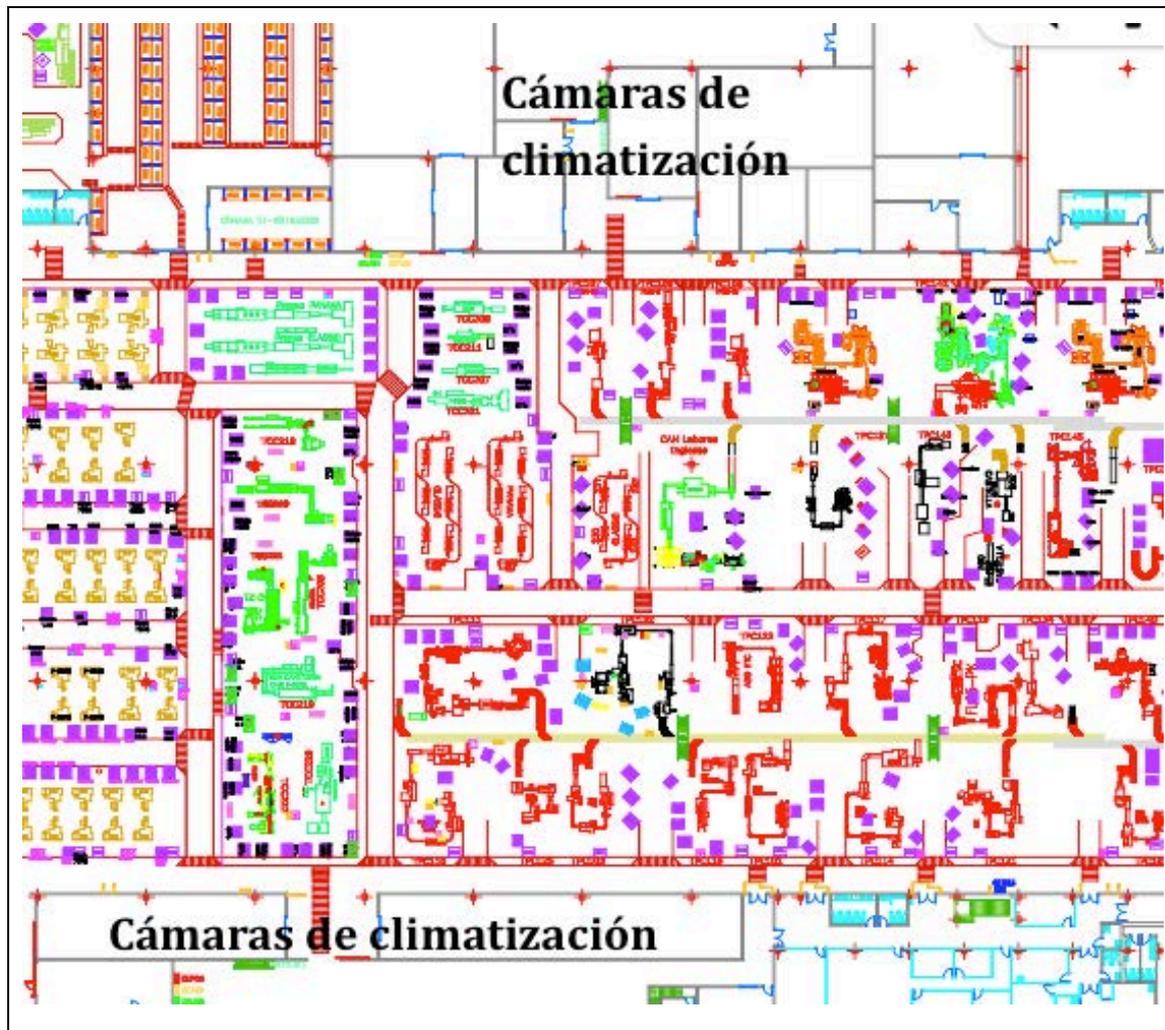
Plano de la situación de Cámaras de climatización. [Fuente: Elaboración propia]
